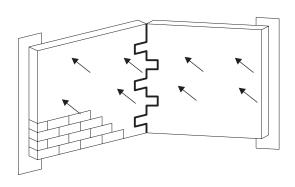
Разрушение стены из блоков YTONG нагруженной перпендикулярно к плоскости
